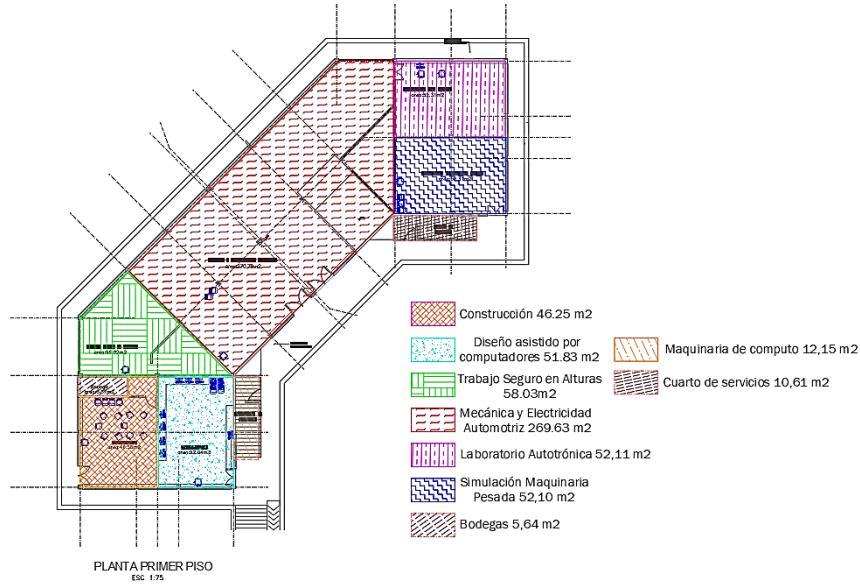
| Planta distribución de espacios actual de primer piso bloque 8 - Fuente: Propia
